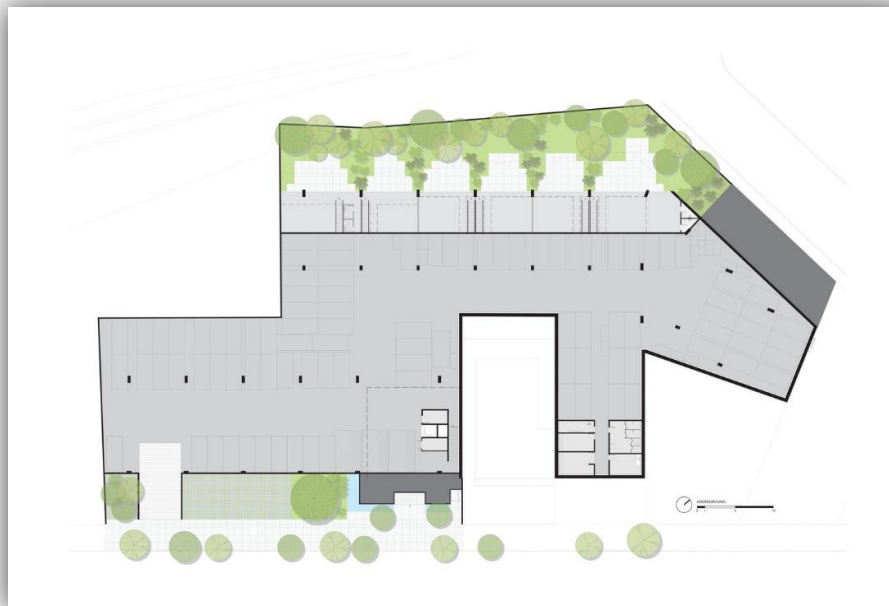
Planta Baixa- Subsolo Fonte: archdaily.com.br
